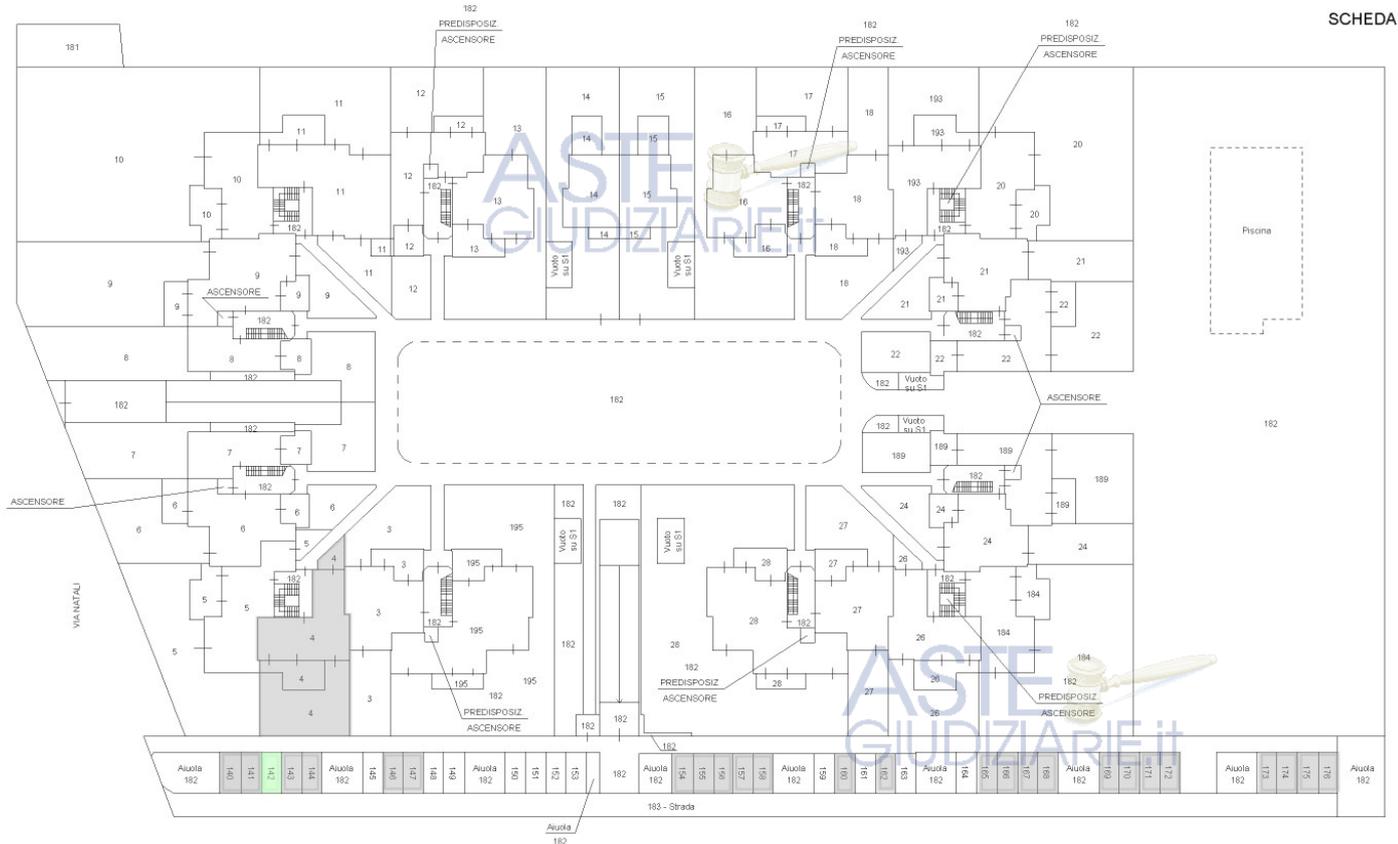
Piano interrato - Individuazione immobili su planimetrie catastali
